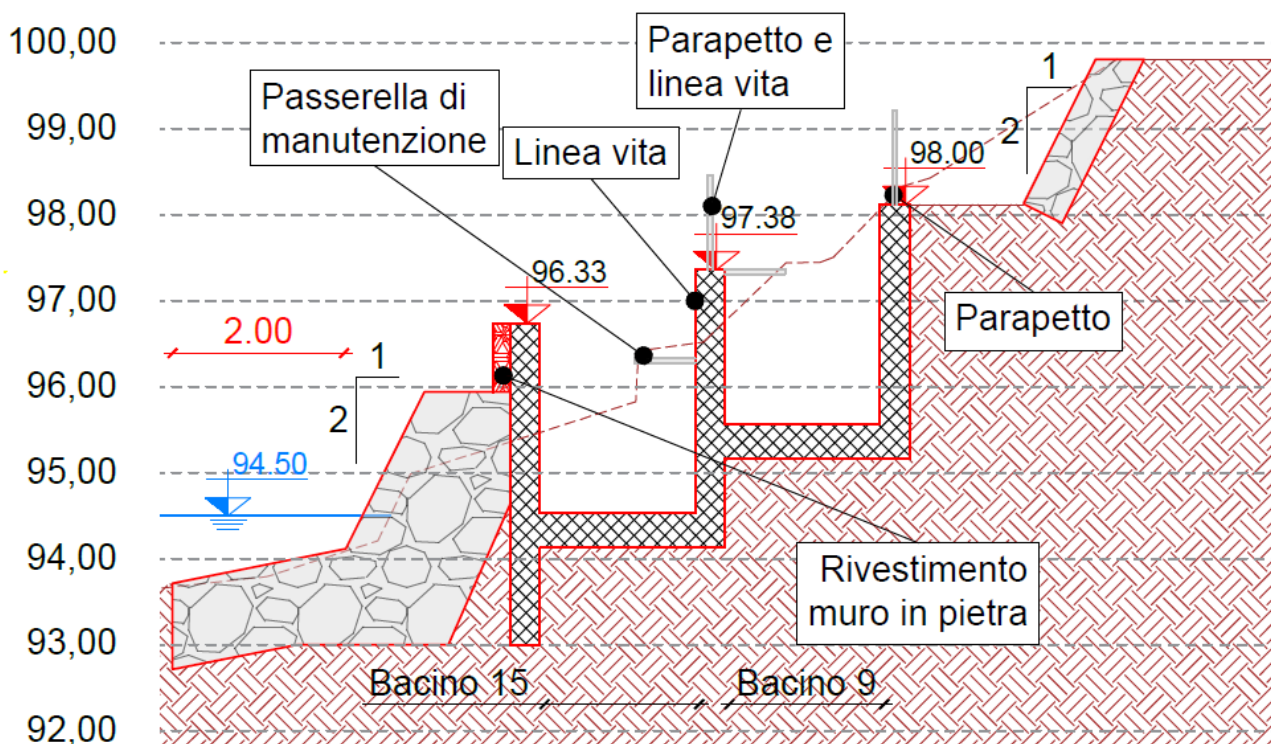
Vista della sezione E-E, estratto della tavola C.1.4.
